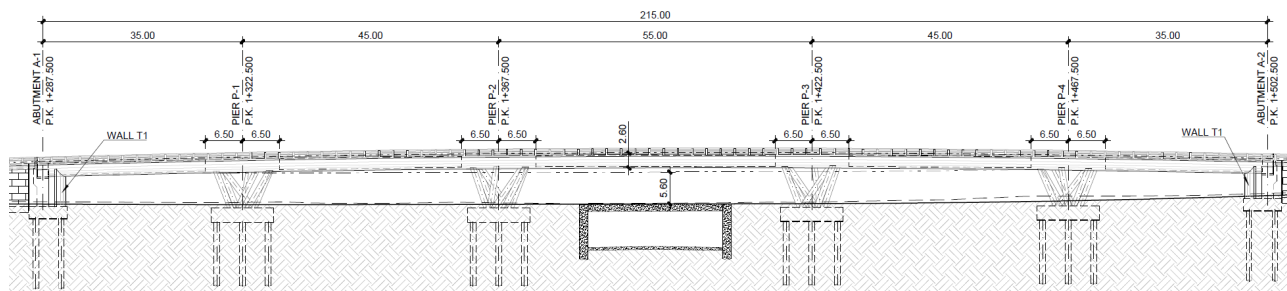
Alzado del puente integral, empotrado sobre las cuatro pilas.
